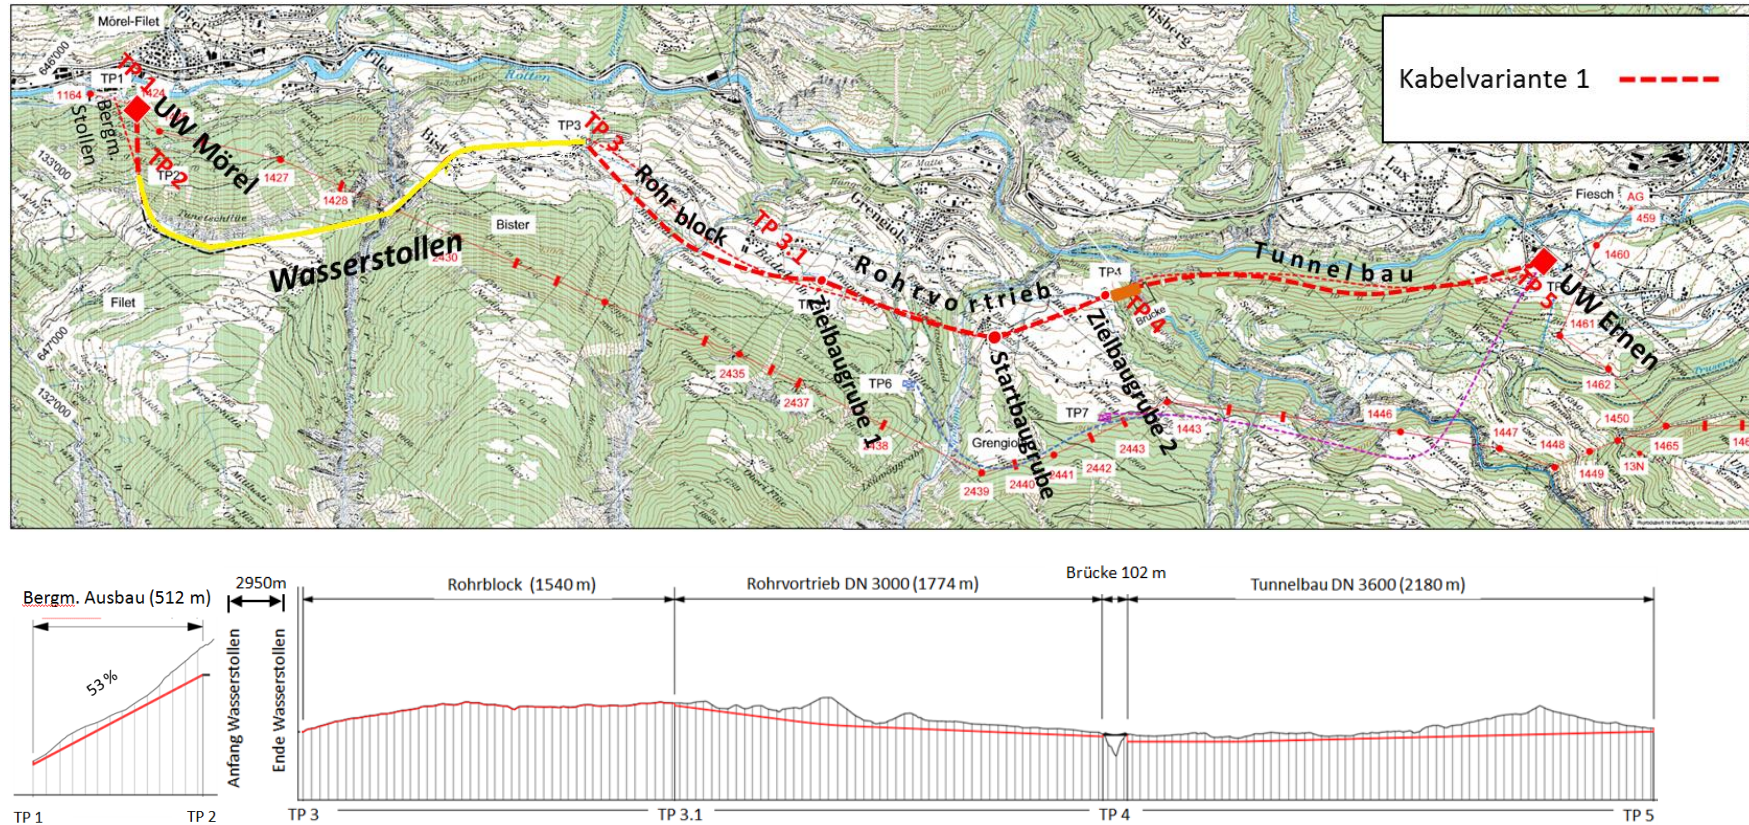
Skizzierung des Trassenverlaufs der Kabelvariante 1 im Lageplan (oben) und Höhenplan (unten)¹
